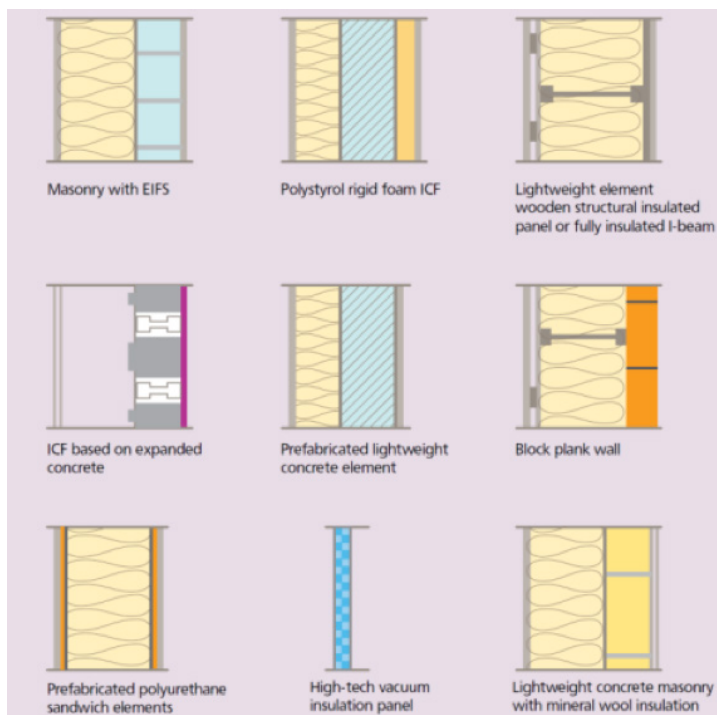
Некоторые решения для изоляции оболочки здания: стен и фасадов [5].
